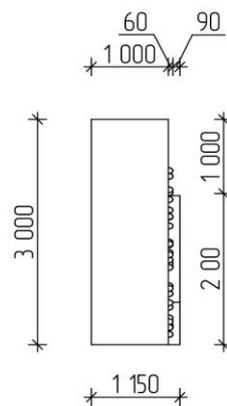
Чертеж скалодрома. Вид сбоку
